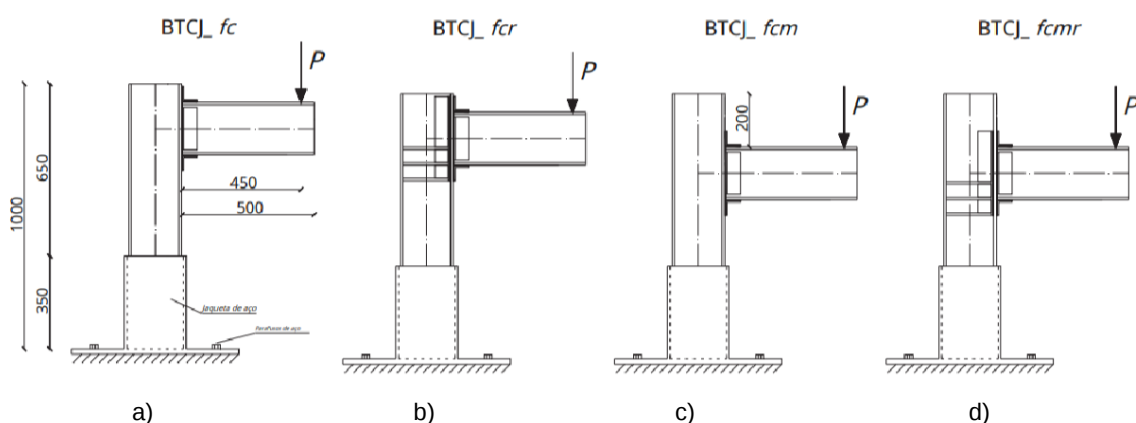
Detalhes das conexões viga-coluna testadas (Ascione *et al.*, 2016).
